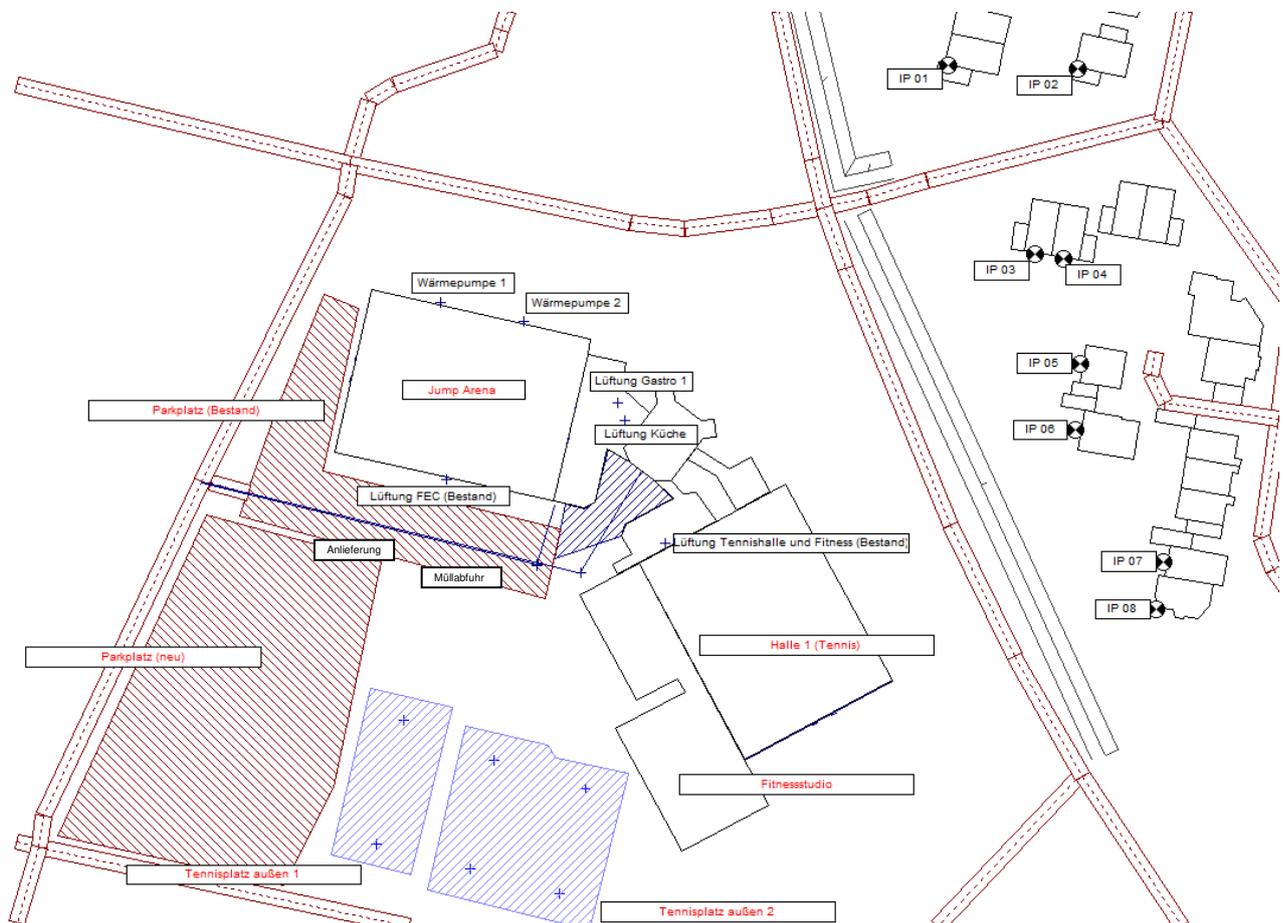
Lageplan mit Emissions- und Immissionspunkten
